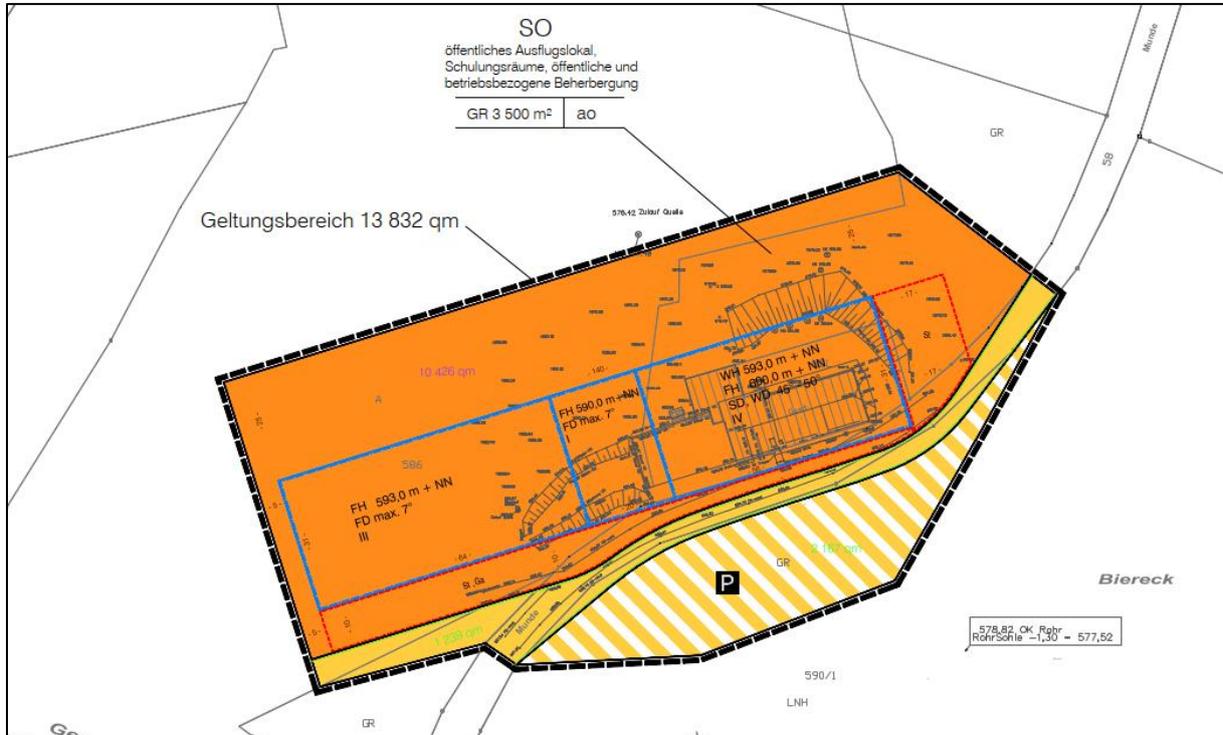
Bebauungsplan „Biereck“ (2017); Quelle: Gemeinde Hofstetten
